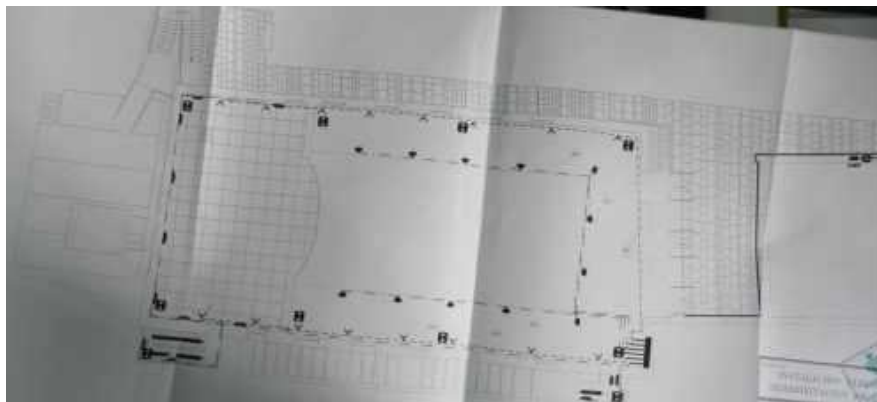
Instalación eléctrica planta baja (GÓMEZ PÉREZ, M.S, 1998).
